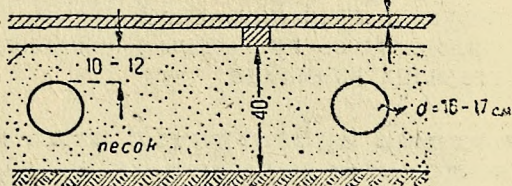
Система временного отопления землянки посредством железных труб, проложенных в песок под настилом нар.
